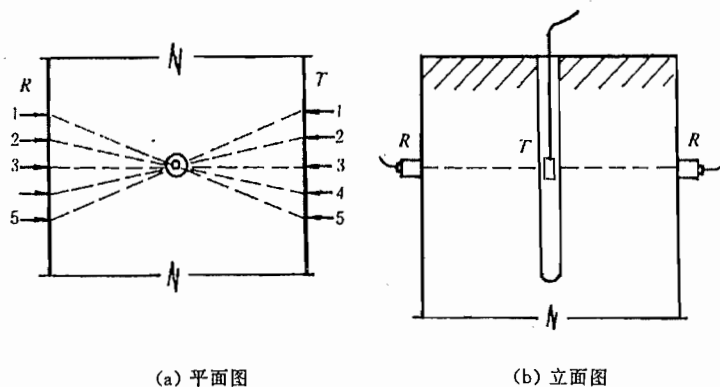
混凝土缺陷检测钻孔法测点布置
